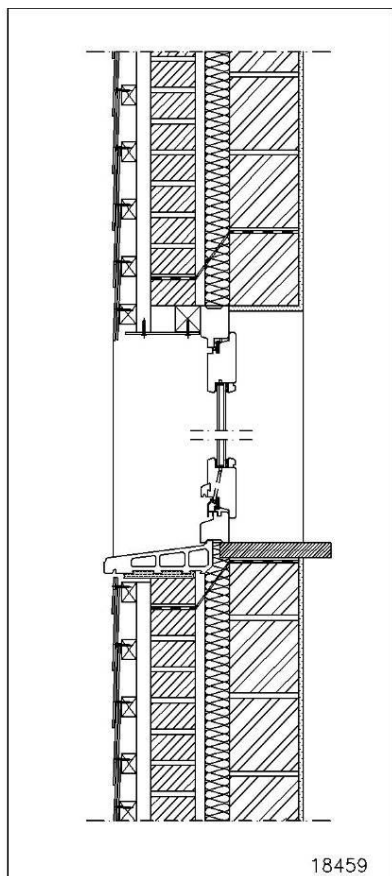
Exemple coupe verticale d'une fenêtre en retour
